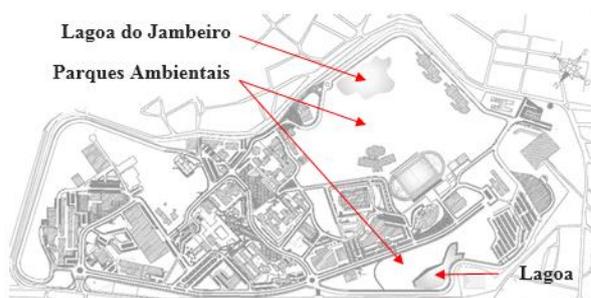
Planta de Situação do Campus. Fonte: PRECAM, 2014.
